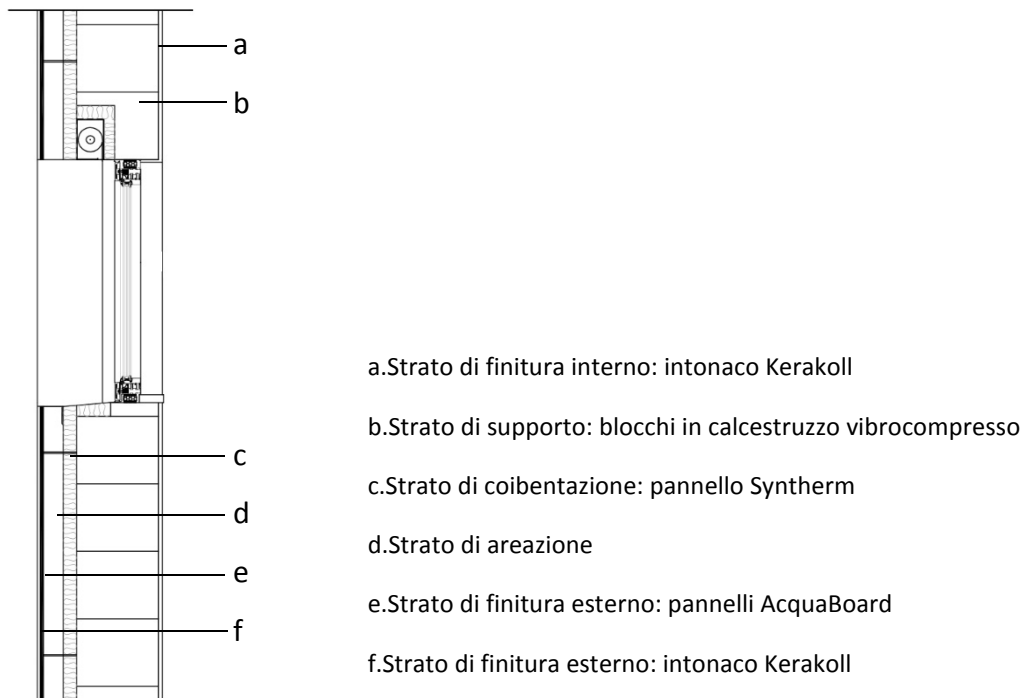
Dettaglio parete perimetrale. Scala 1:20.
